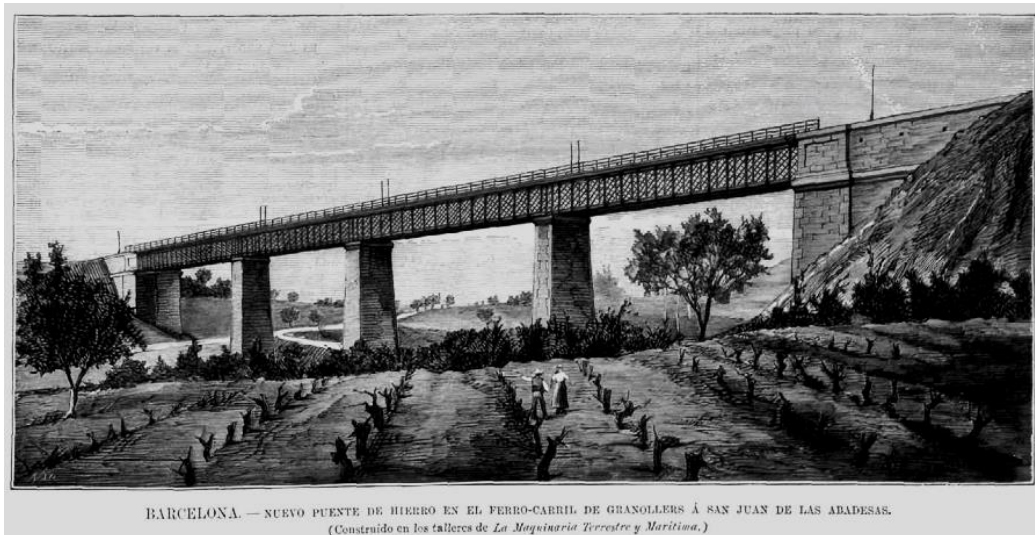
Puente de hierro para el ferrocarril entre Granollers y San Juan de las Abadesas construido por la Maquinista Terrestre y Marítima. 1875. Grabado publicado en *La Ilustración Española y Americana* ©
